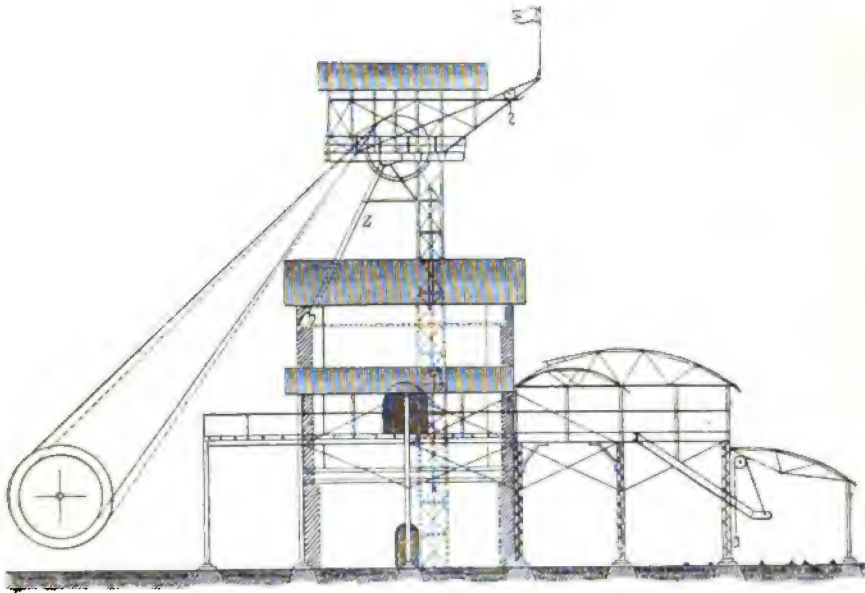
Fördergerüst nebst Ladebühne der Zechen Rheinelbe und Alma bei Gelsenkirchen.
